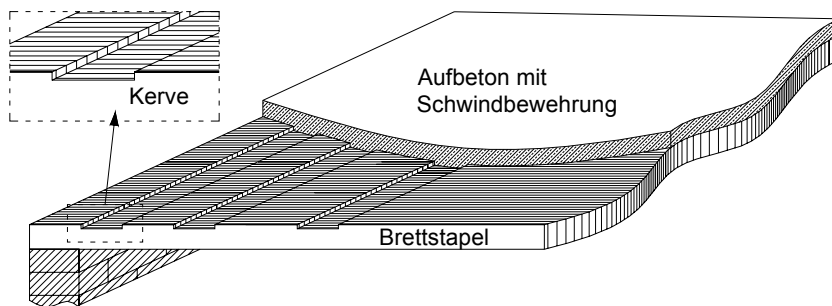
Brettstapel-Beton-Verbunddecke mit Kerfen
